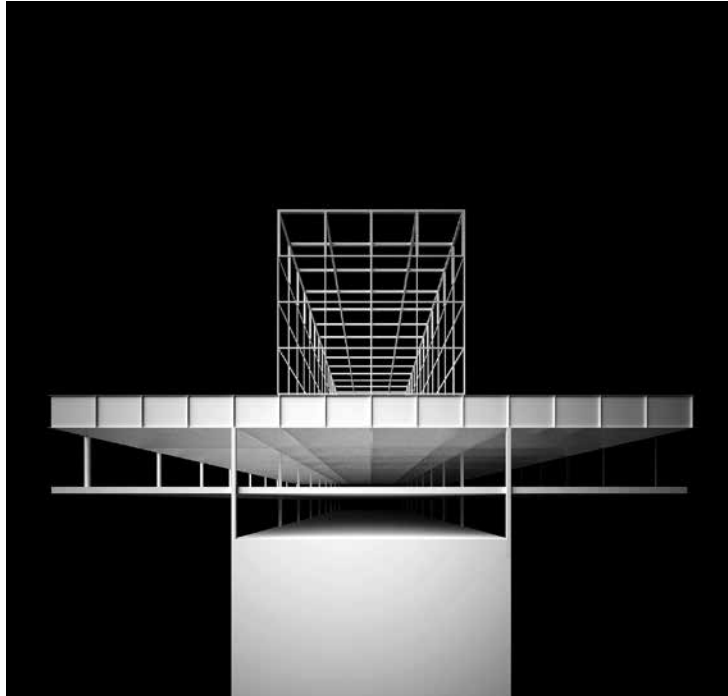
CONCEPTO ESTRUCTURAL. NUEVA SEDE PARA LA EMPRESA VITEOS S.A., LA CHAUX-DE-FONDS (SUIZA). PROYECTO EN CURSO, 2021-2026. FUENTE: GNWA
